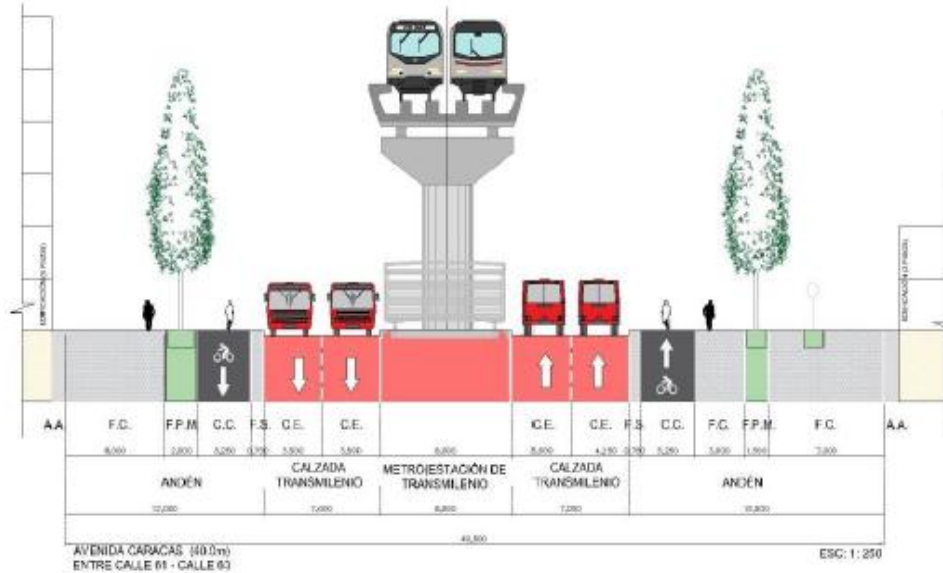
Perfil vial propuesto. Elaboración Propia Consorcio Metro Bog
